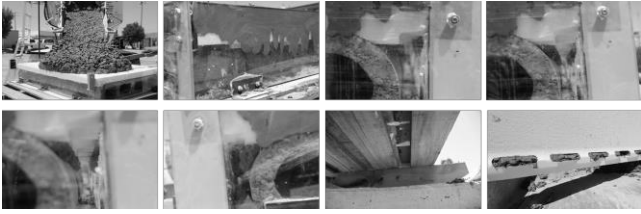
Prueba con el concreto seco (revenimiento 10 cm).
